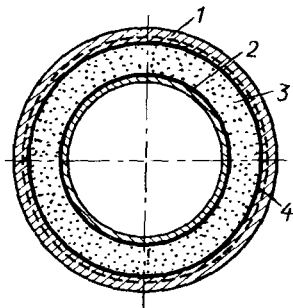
Принципиальная схема бесканального трубопровода:
